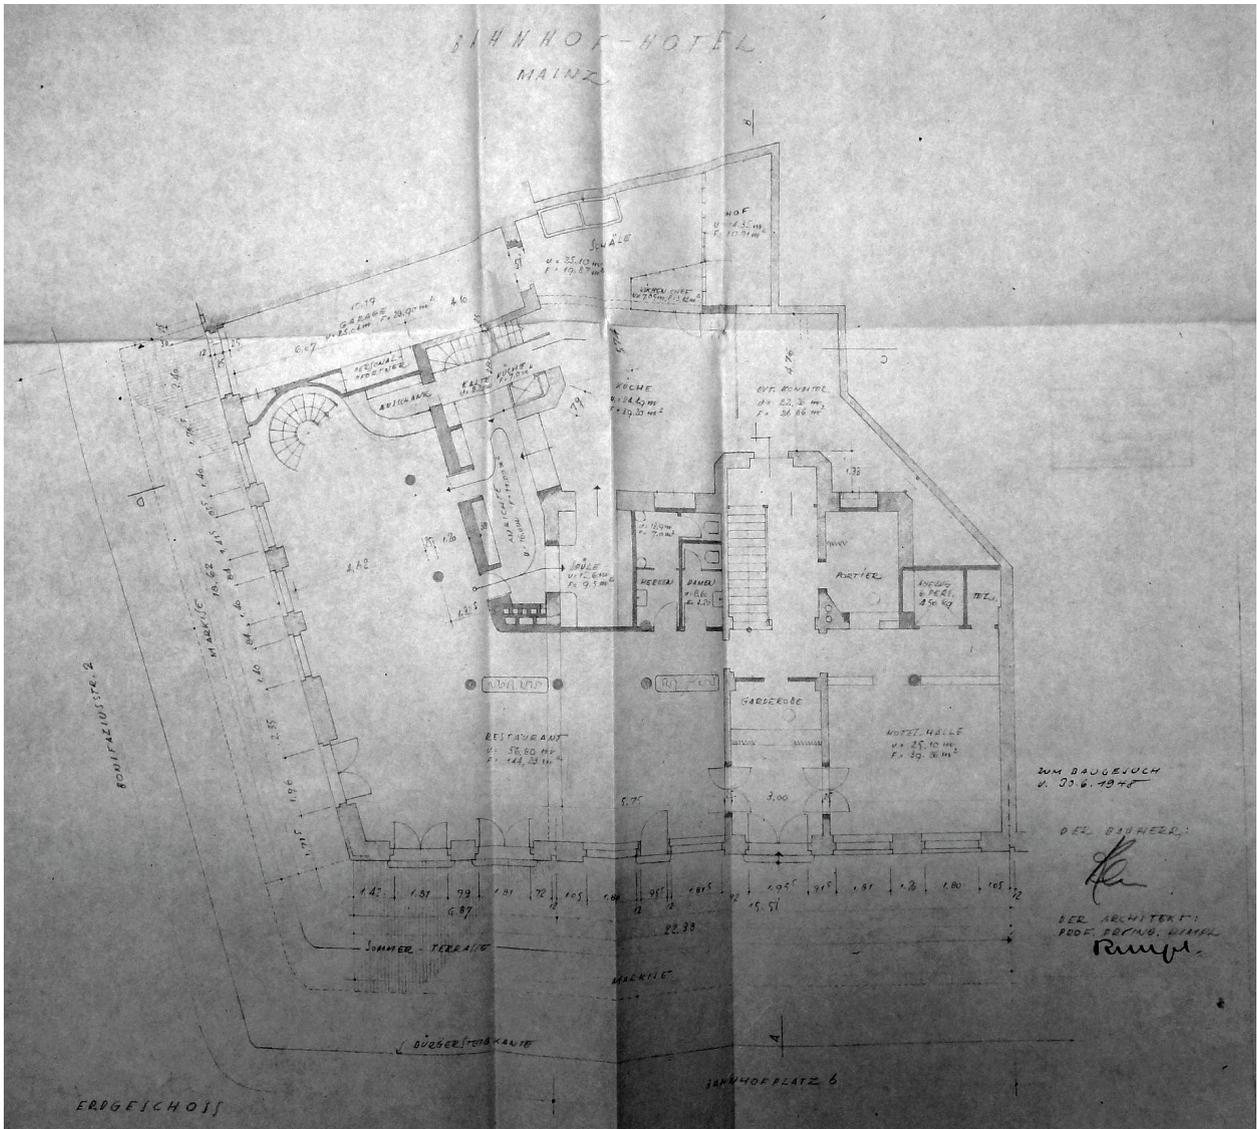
Baugesuch, Bahnhofstraße 6-8, Bahnhof-Hotel, Grundriss, 1948
